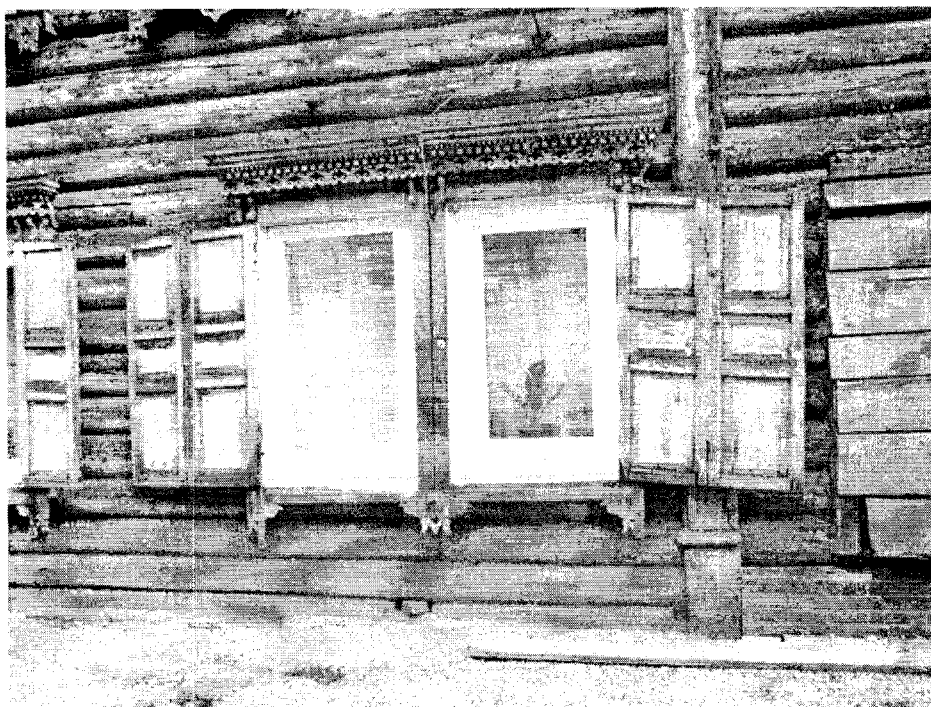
Фрагмент продольного юго-западного фасада. Сдвоенное окно 1-го этажа
